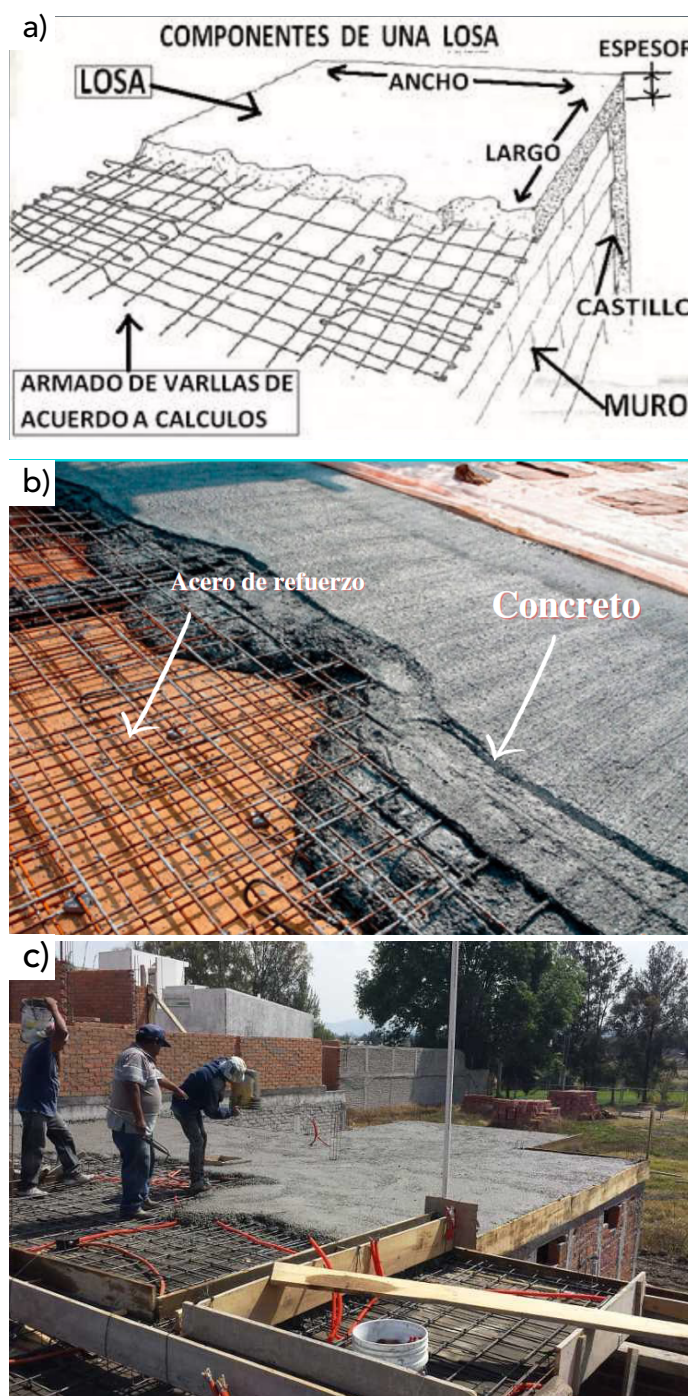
Losa maciza de concreto armado a) [8]; b) y c) [9]. Losa nervada o reticular.
